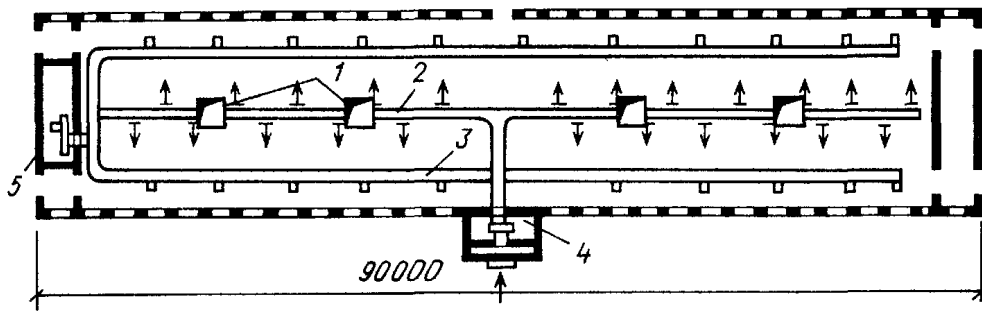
Схема вентиляции помещений животноводческого здания при подаче воздуха через два параллельных воздухопровода и удалении воздуха через шахты, навозные каналы и отверстия в стенах
